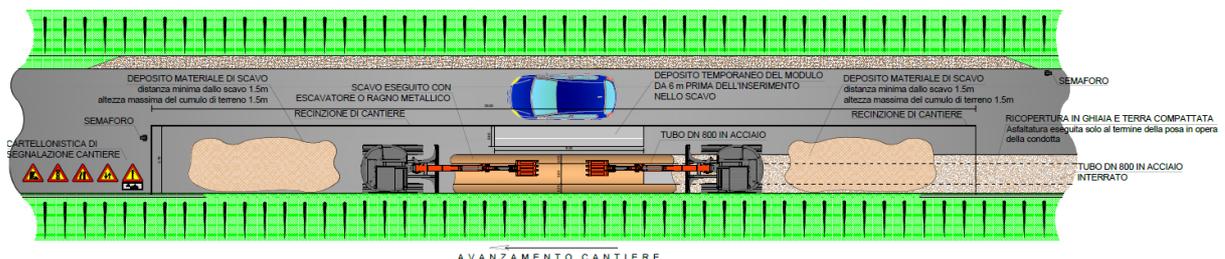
Esempio di planimetria di un cantiere mobile.
